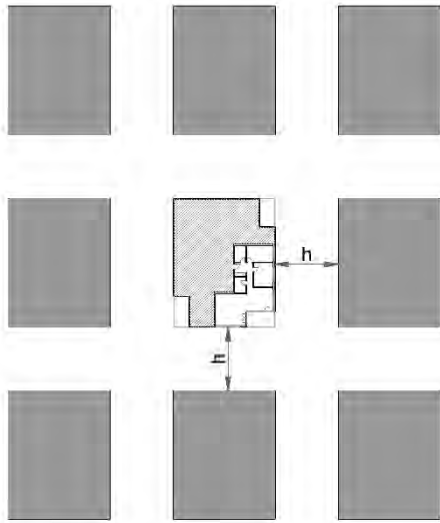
Grundrissplan mit den umliegenden Gebäuden.
